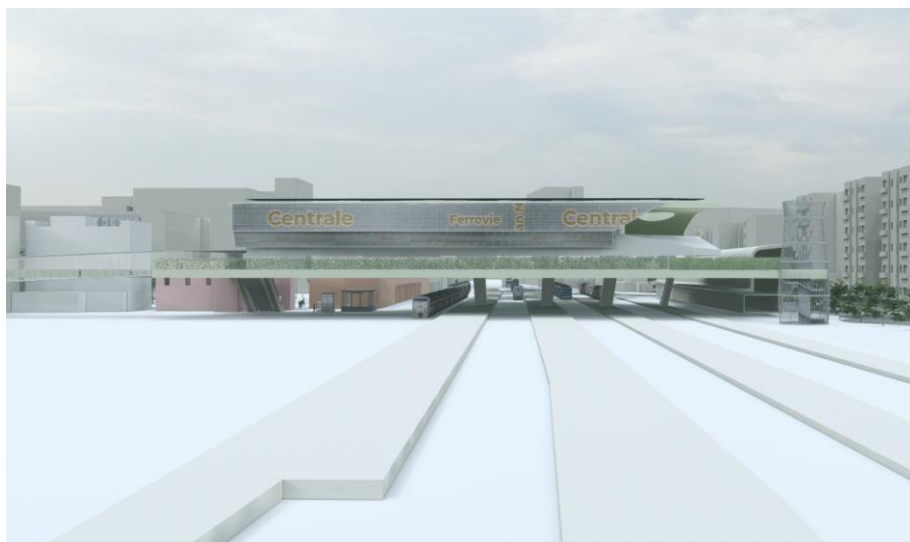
Stato di progetto – Vista dall'alto del complesso degli interventi. In primo piano il giardino pensile
